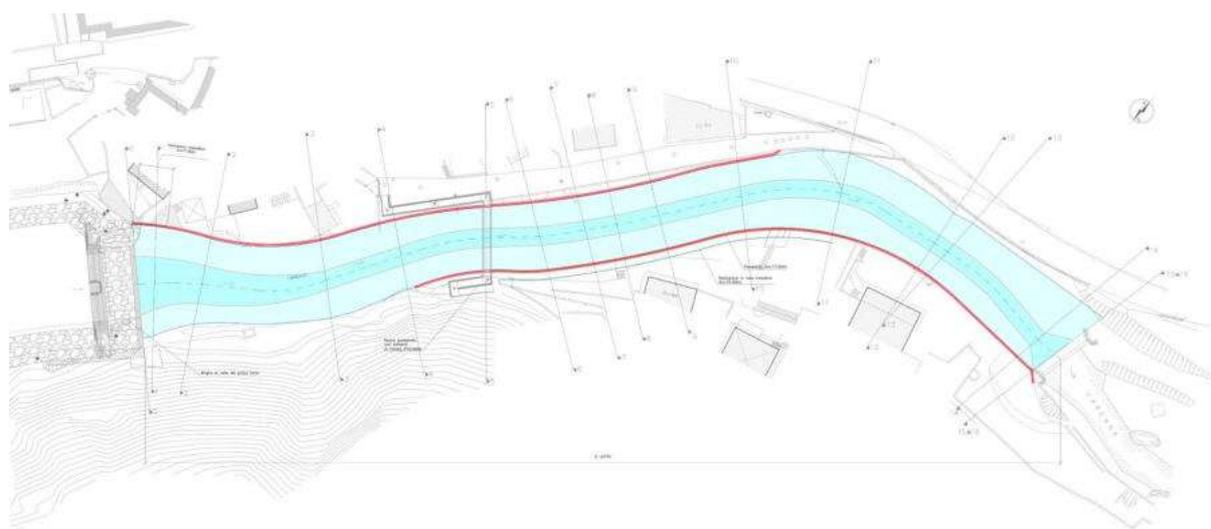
Planimetria di progetto ad opere finite (adattata da: Progetto Definitivo, tavola n. 3).
